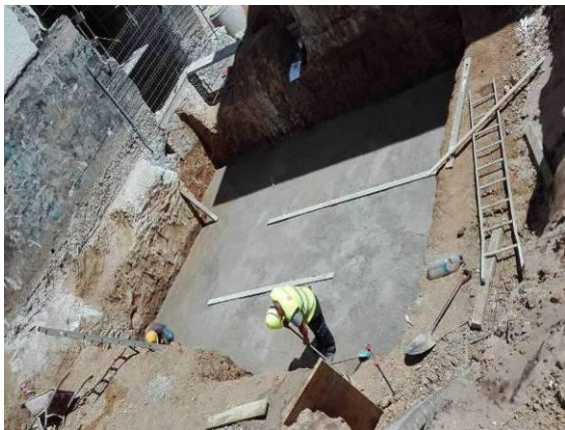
Execução do betão limpeza – sapata da torre do elevador
